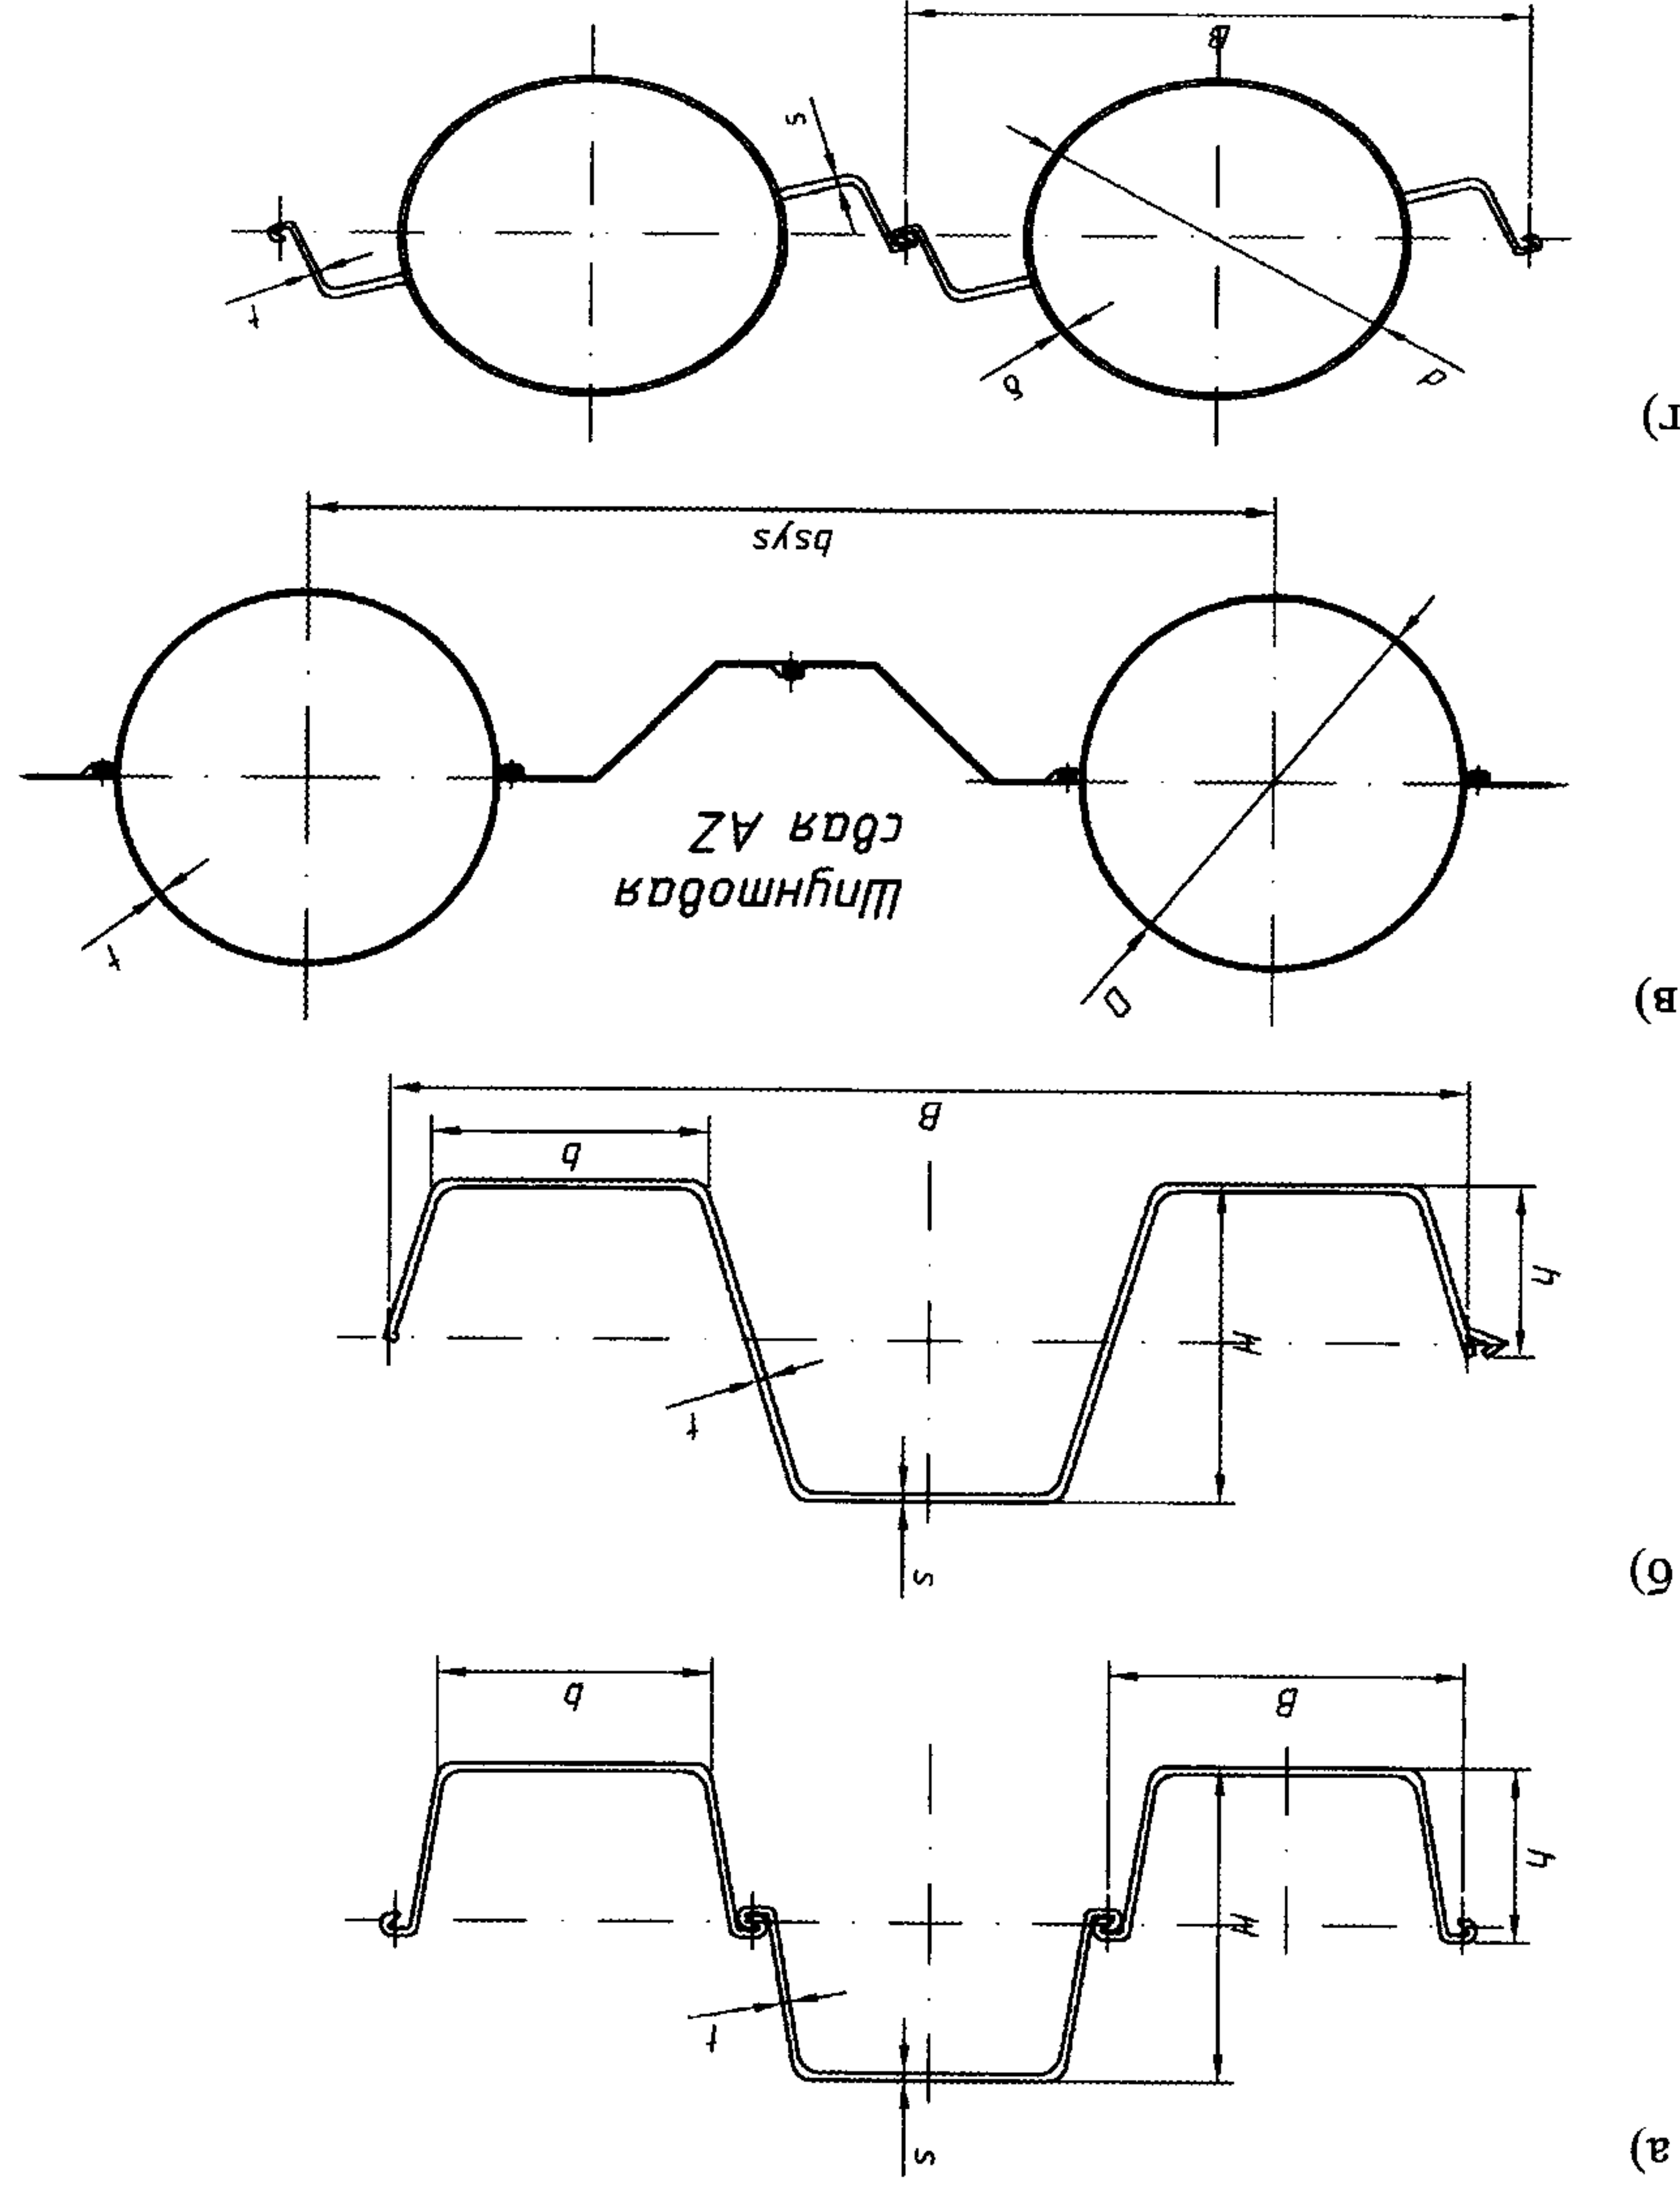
Эскизы поперечных сечений стальных шпунтовых свай
